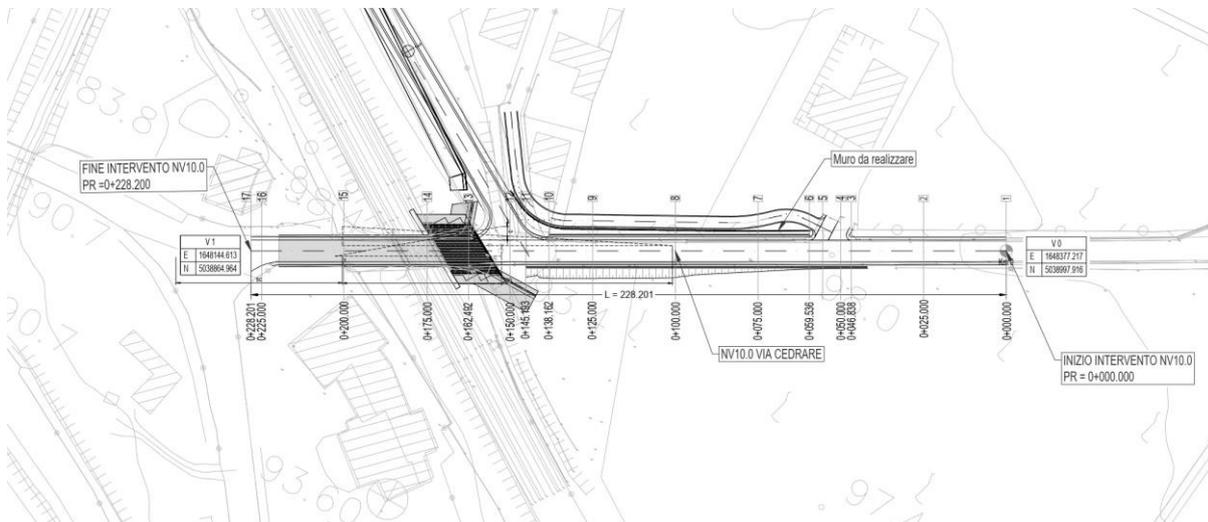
NV10 – Stralcio planimetrico su rilievo di Via Cedrare
